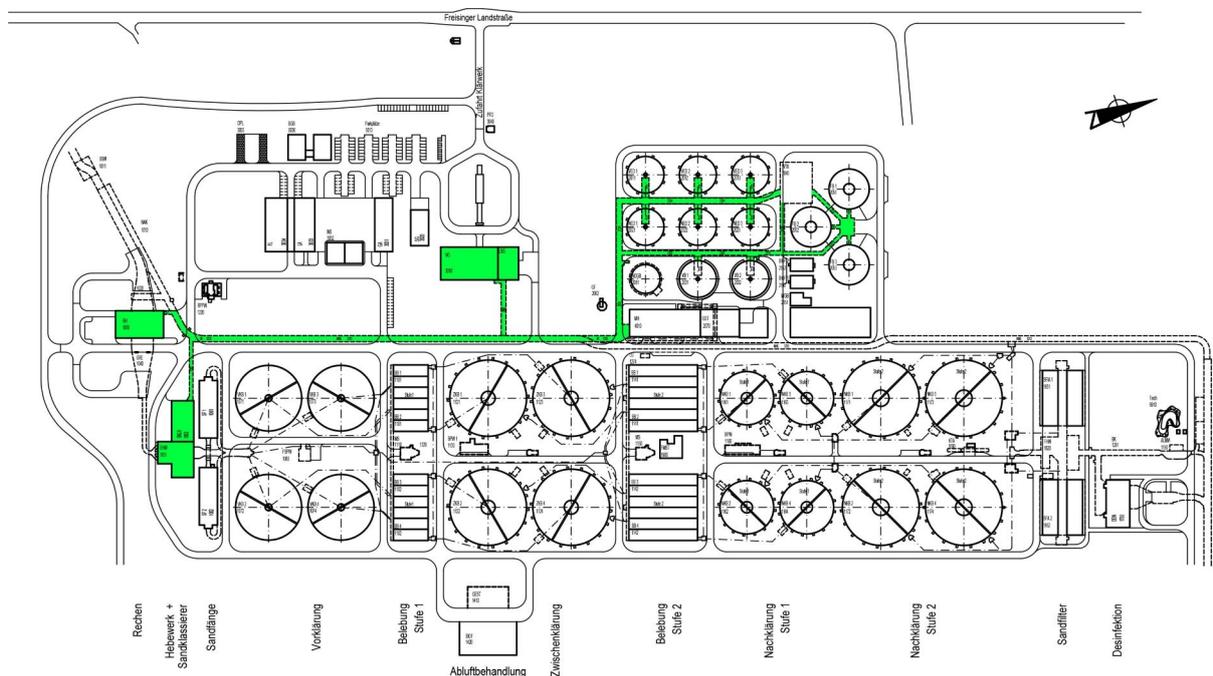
Lageplan K LW II: Von Maßnahme betroffene Bereiche sind grün gekennzeichnet.
